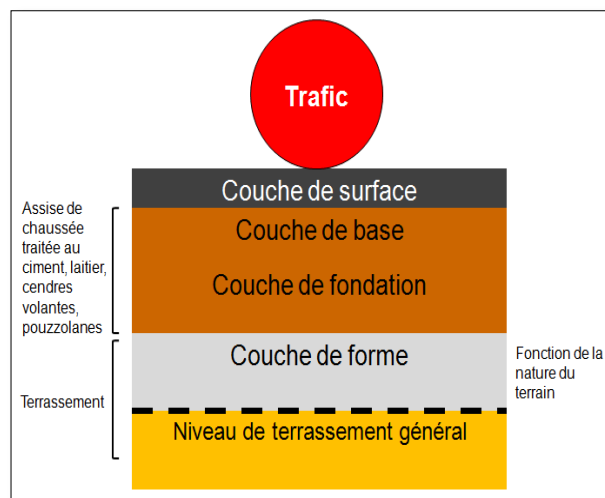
structure type d'une chaussée semi-rigide.
